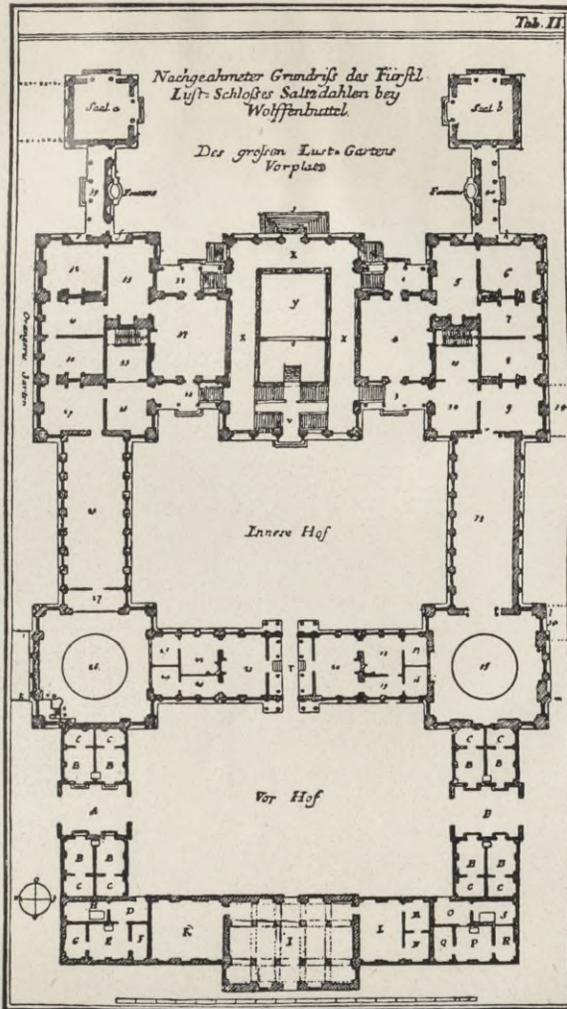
Schloß Salzdahlum, Grundriß nach L. Sturm¹⁾
